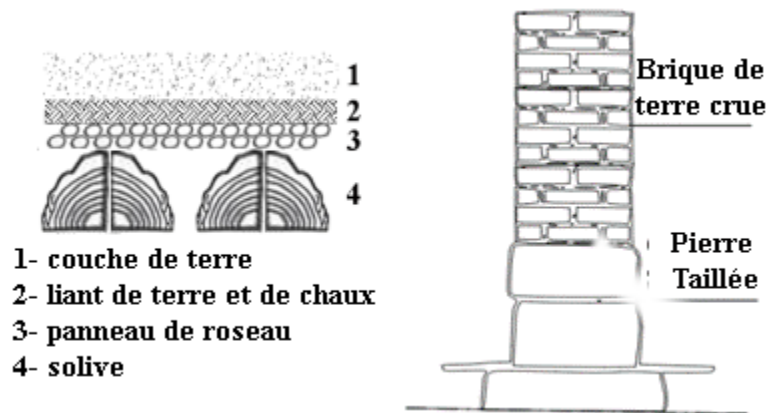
Coupes de détail sur la technique de constructions pour les toits et les murs
